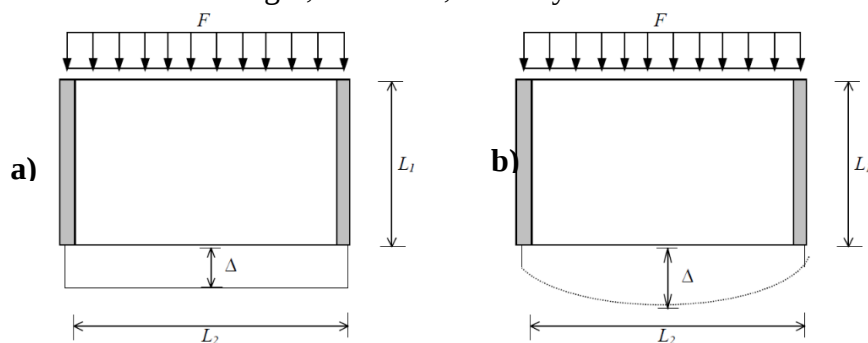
Hipótesis sobre la deformación de losas ante cargas laterales: a) diafragma rígido y b) Diafragma flexible, de Tena Colunga (2020).
